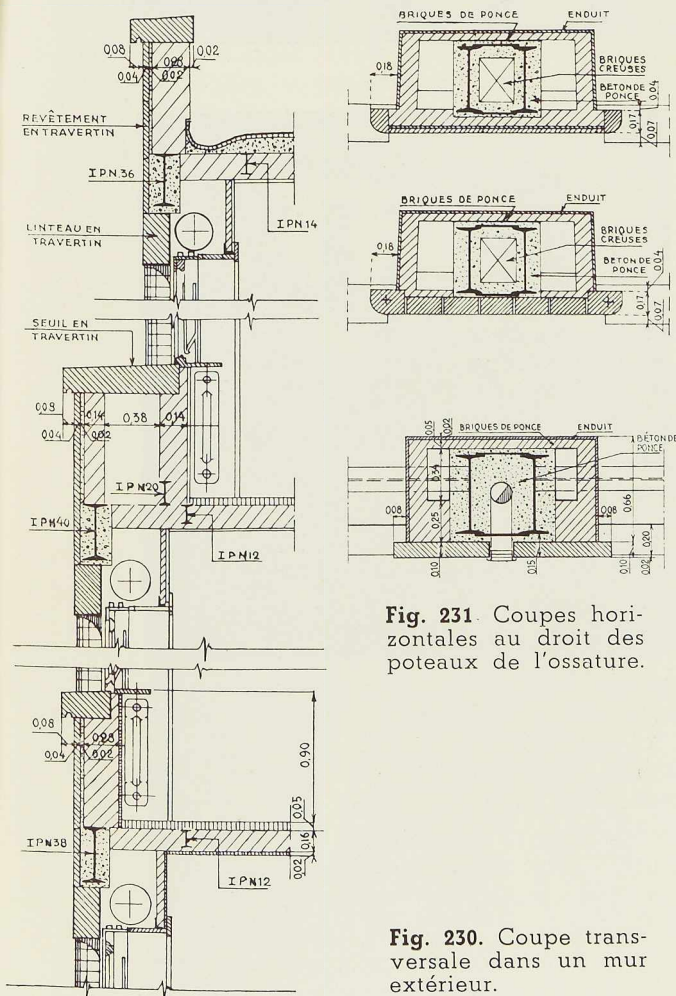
Coupes horizontales au droit des poteaux de l'ossature.
